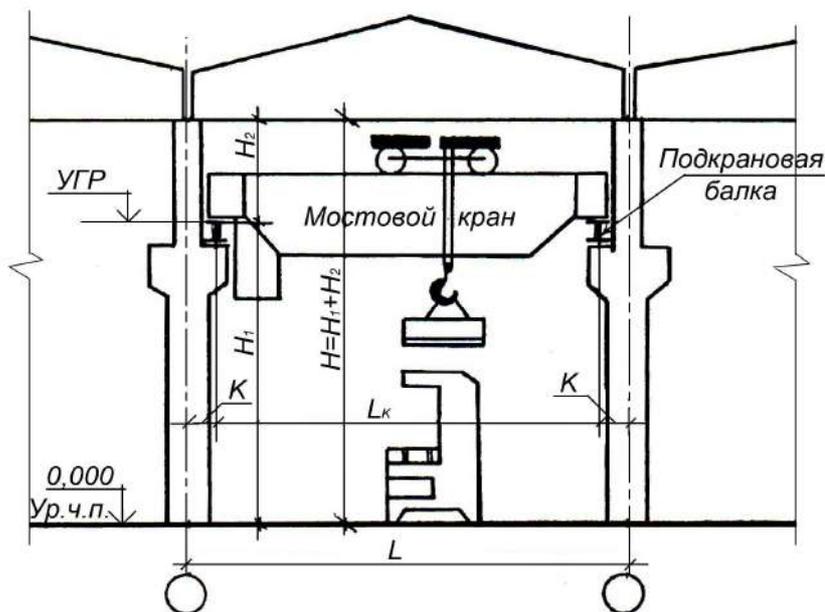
Поперечный разрез многопролётного ПЗ с мостовым краном (схема)
